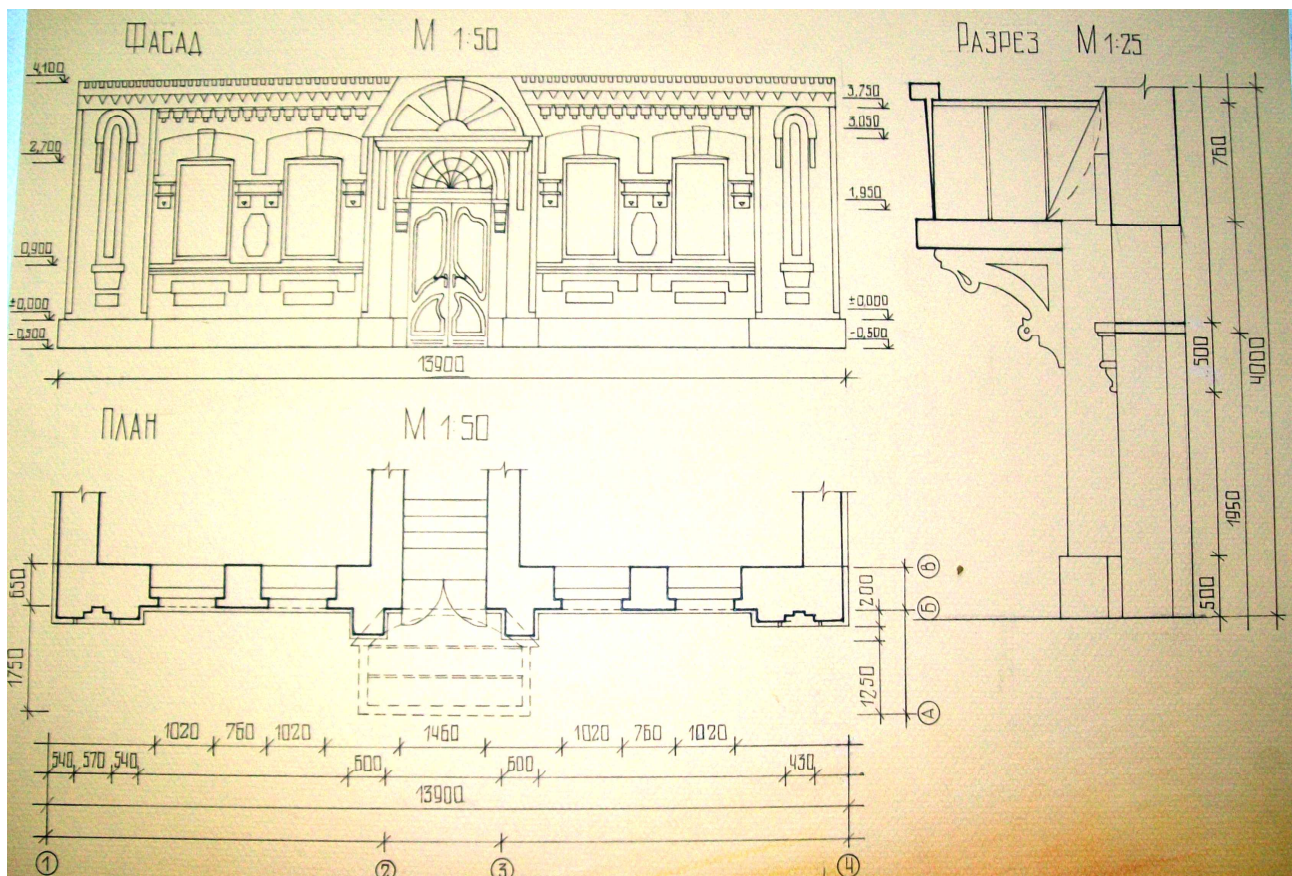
Ескіз входу в громадську будівлю (план, фасад, розріз, перспектива)
